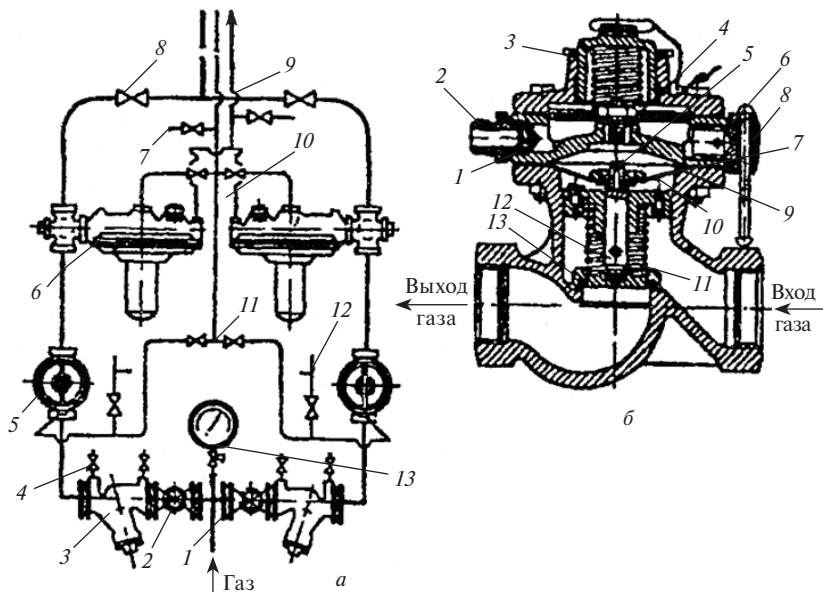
Устройство и схема обвязки шкафной ГРУ:
